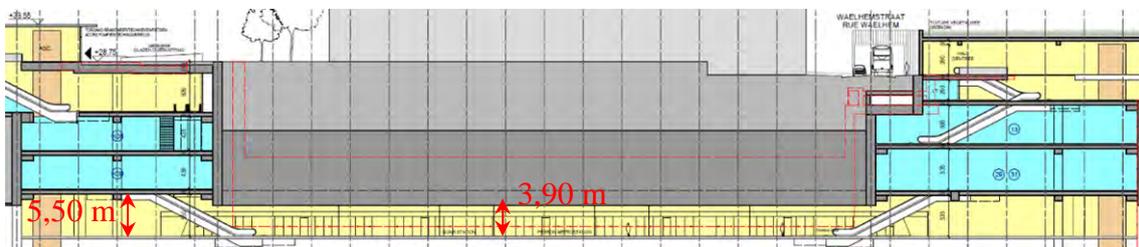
Coupe longitudinale de la station Verboekhoven pour l'alternative bitube (BMN, 2020)
